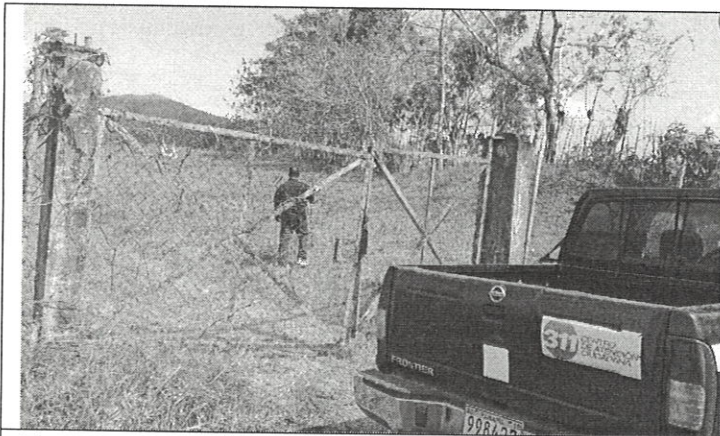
Entrada al proyecto denominado Construcción Residencial Villas Del Rosario.
